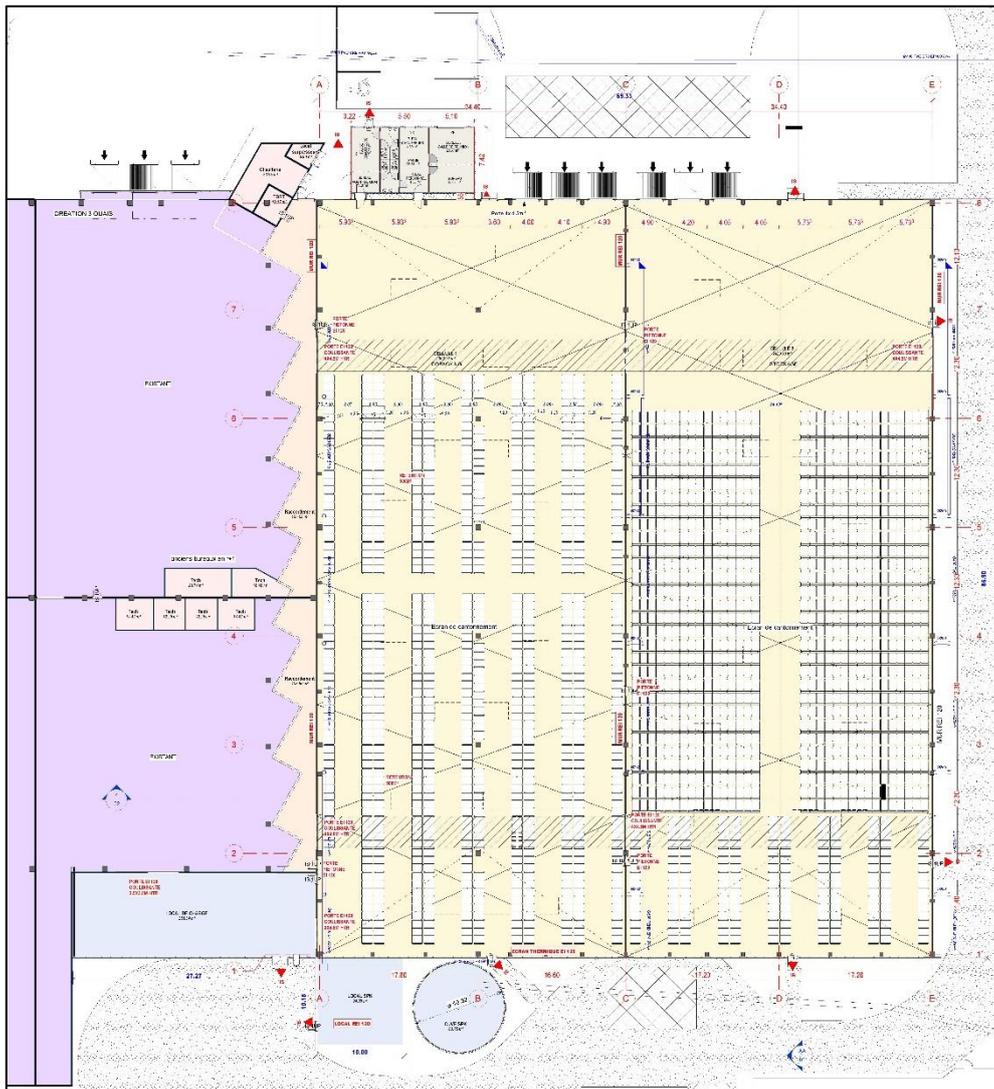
Plan de niveau 0 du projet de la société COSMELOG (source : ACONSTRUCT)
